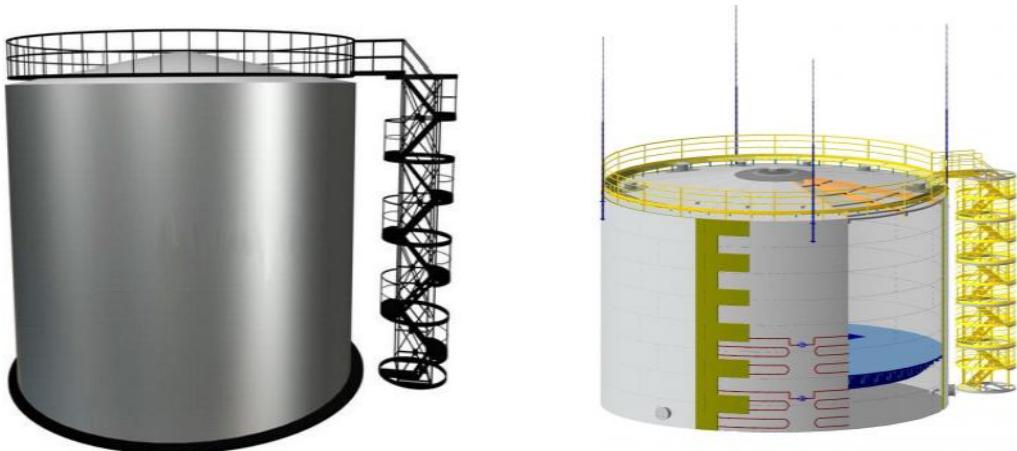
Зовнішній вигляд резервуару РВС-2000
